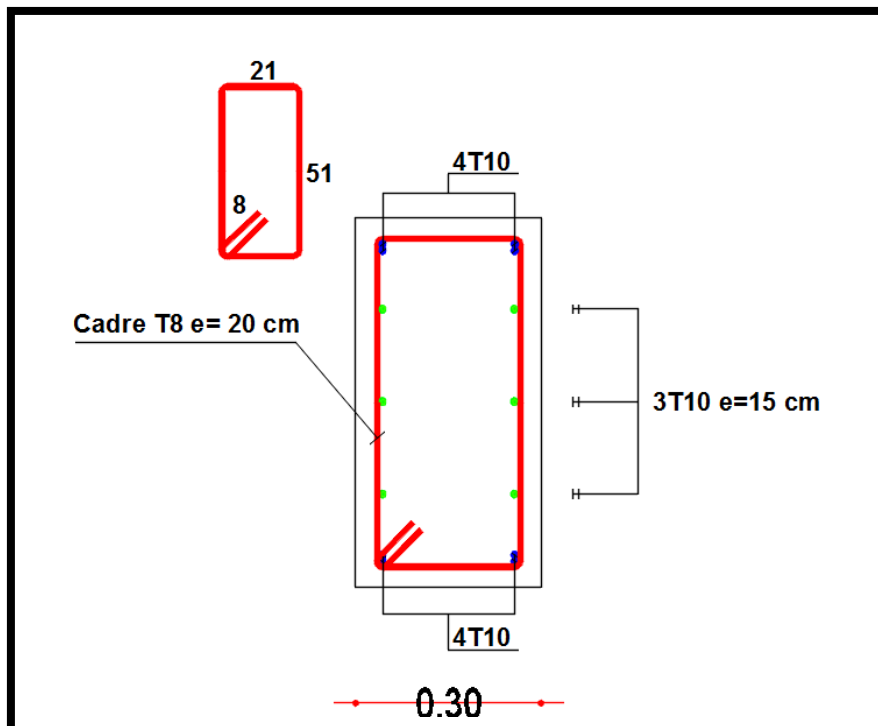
Coupe transversale de ferrailage du linteau sous-sol
